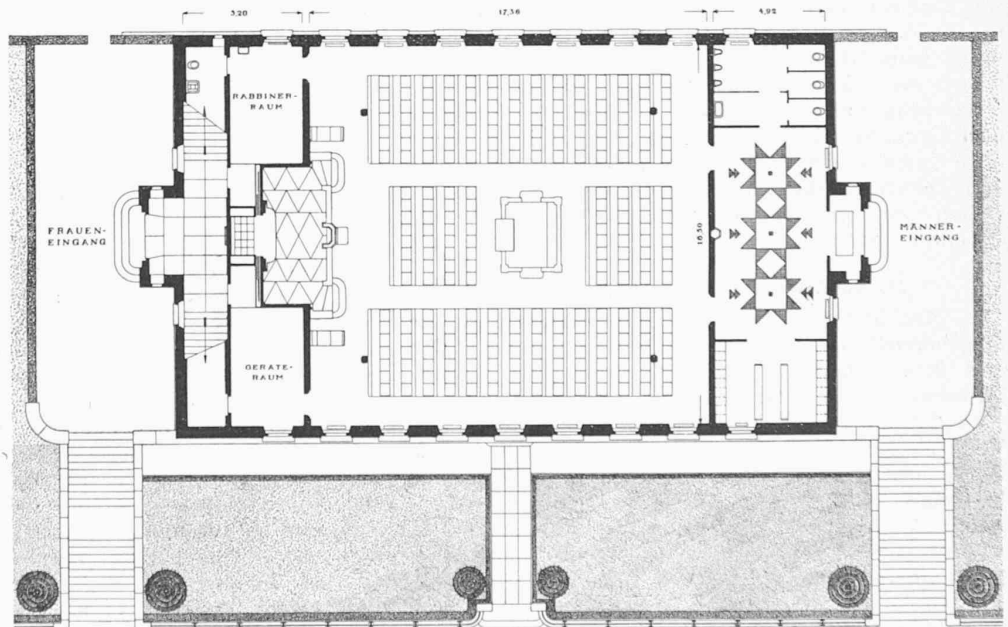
Grundriss vom Hauptgeschoss. — Masstab 1 : 300.
